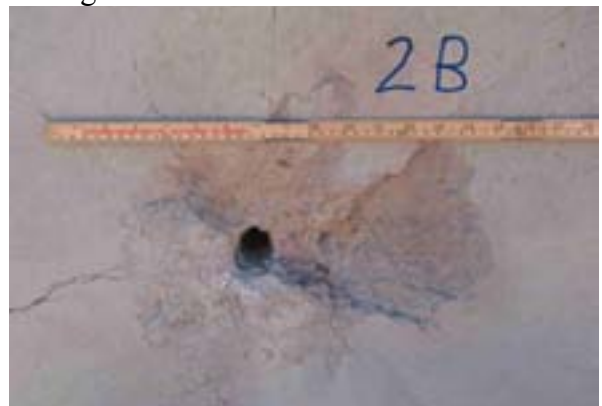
Bild av framsida på det första betongelementet efter skott 2.
